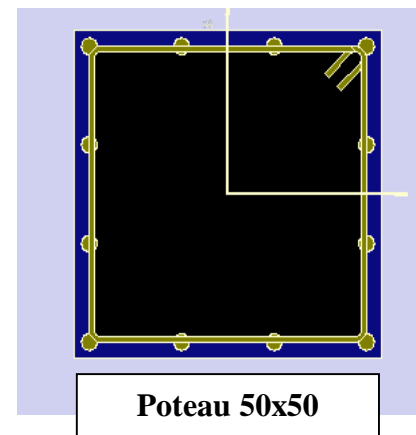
Les sections courantes des poteaux dans le bâtiment de 5 étages.[9]
